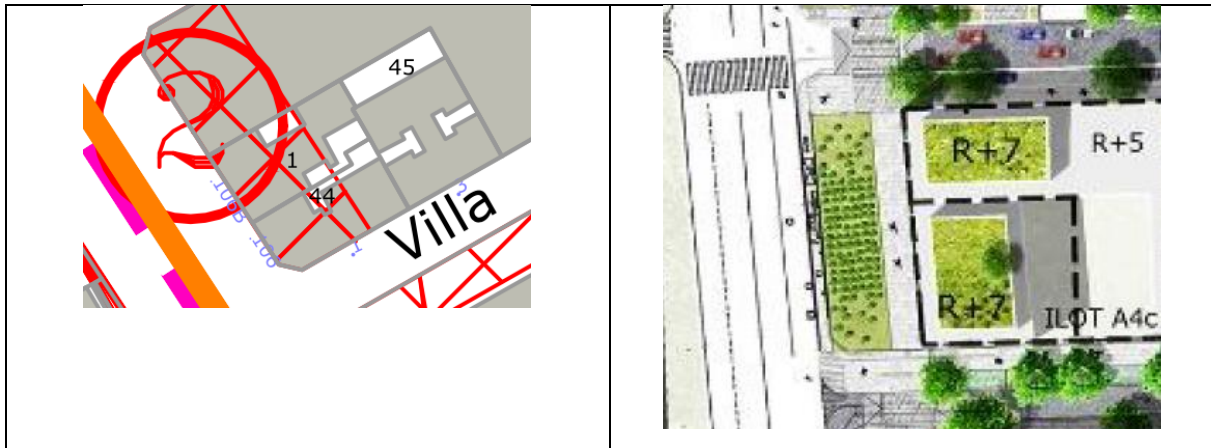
Extraits du plan de zonage du PLU (emplacement réservé n°2 au bénéfice du département des Hauts-de-Seine pour l'élargissement du boulevard de Verdun) et du plan des travaux prévus
